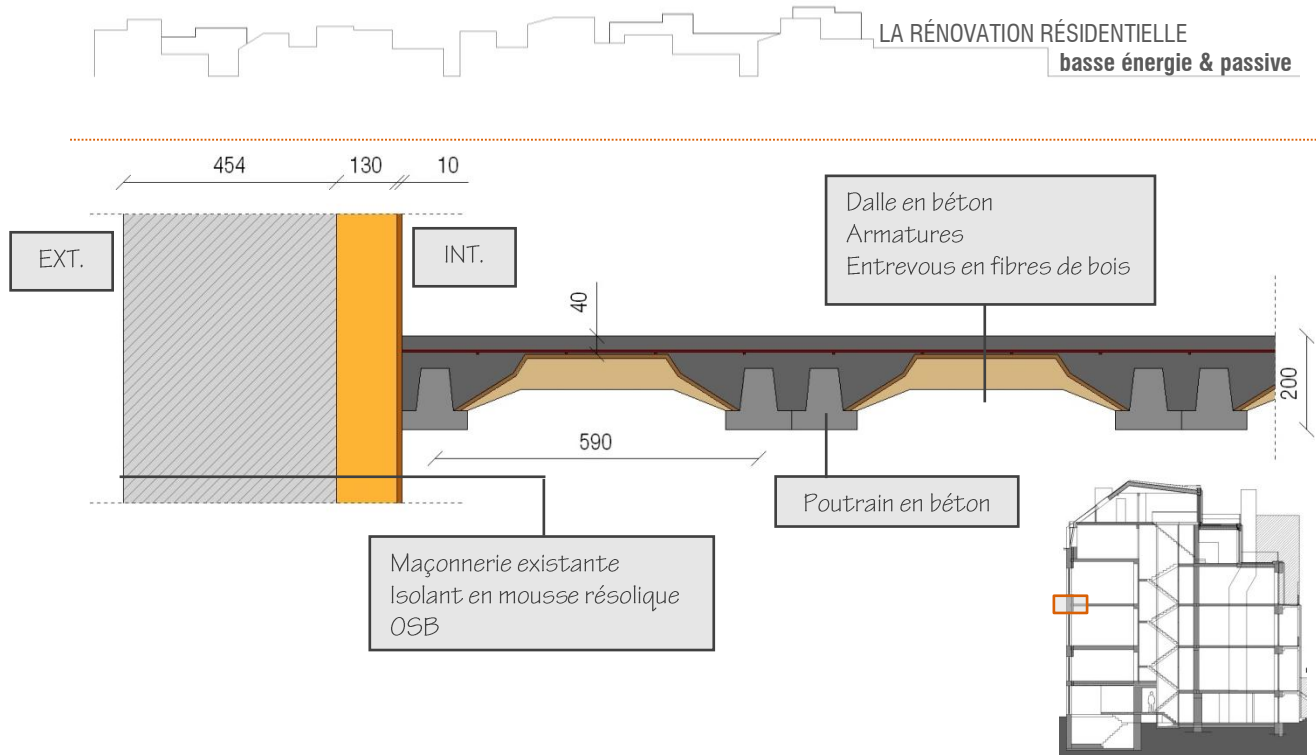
Détail de l'isolation par l'intérieur de la façade avant au droit du plancher, mesures en [mm]
